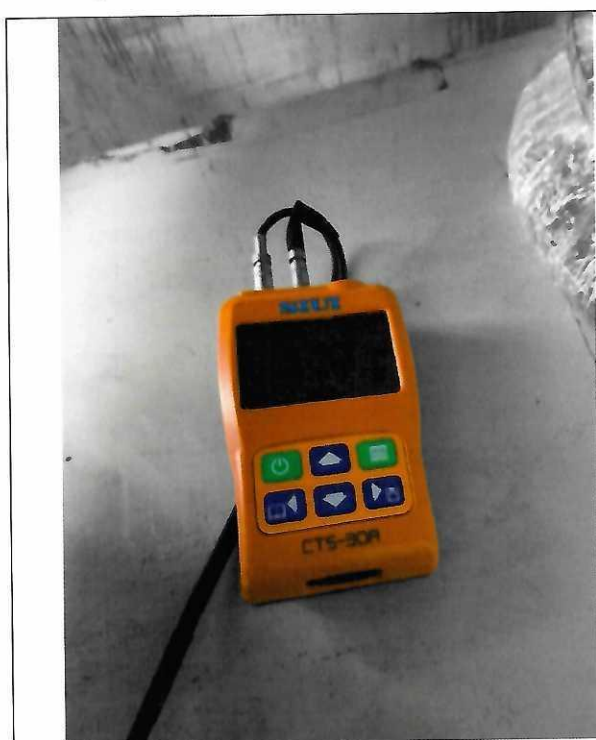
Определение толщины трубопровода тепловой сети на 1-ом этаже
